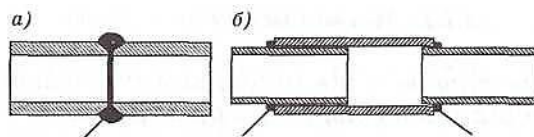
Сварные соединения стальных труб: а – сварка встык; б – сварка в стакан
